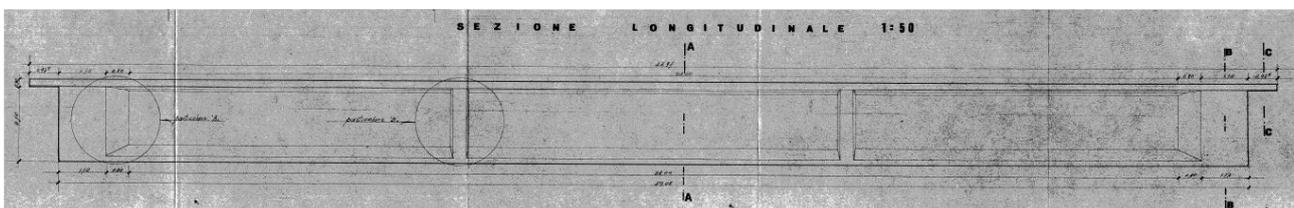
Impalcato a 3 travi in CAP – Sezione longitudinale
